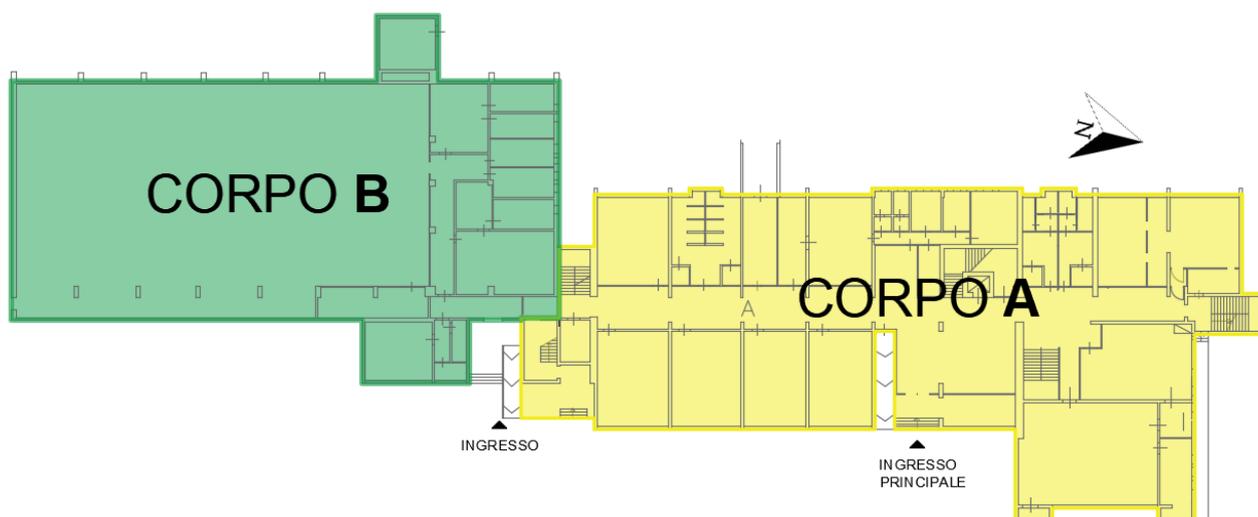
Planimetria generale: indicazione dei corpi che compongono l'edificio oggetto d'intervento
